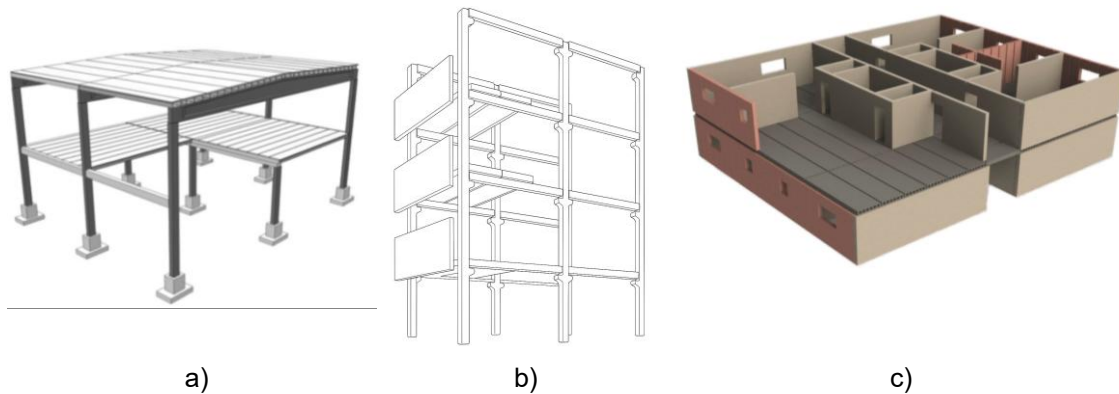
a) Sistema estrutural em pórtico com piso intermédio, adaptado de [9]; b) Sistema estrutural em esqueleto, adaptado de [17]; c) Sistema estrutural em parede, adaptado de [9].
